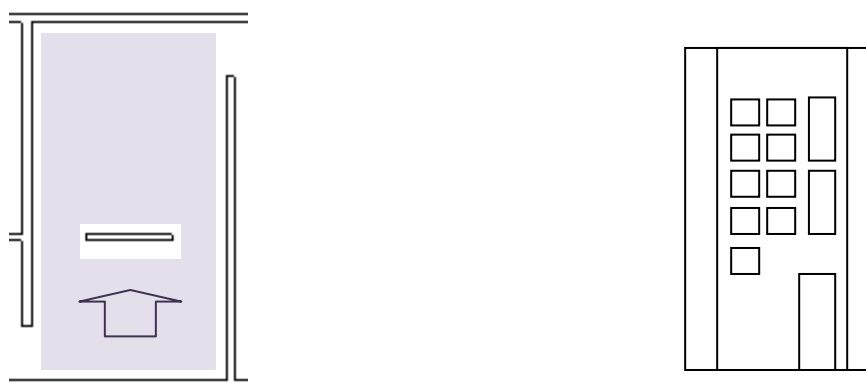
Módulo Mão de obra. Planta baixa e elevação esquemática da parede 03.
